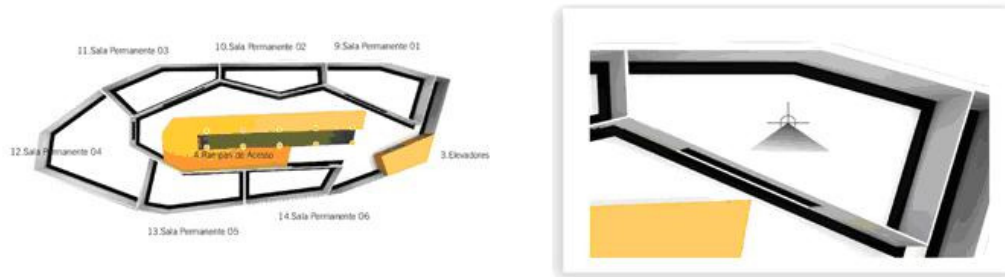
Planta de um dos pavimentos e diagrama de navegação de uma sala do museu.
